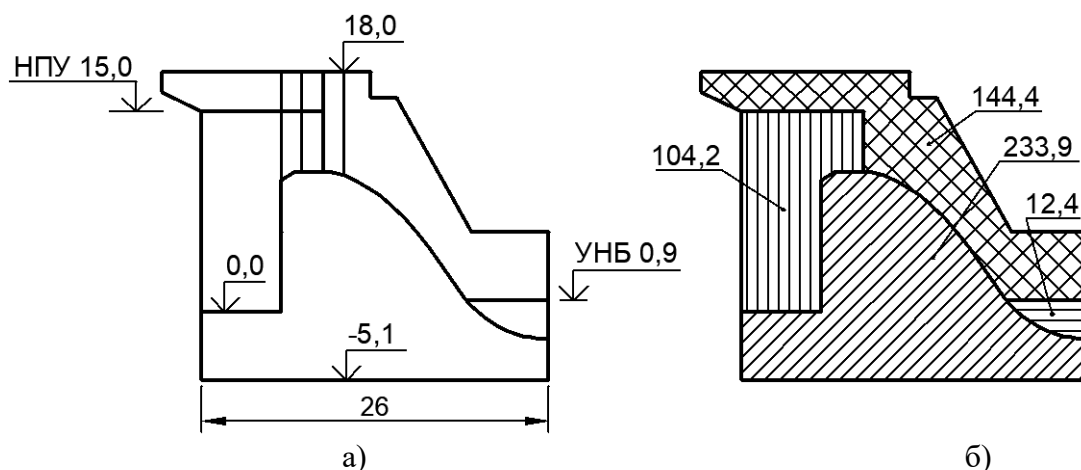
Исходные данные к расчёту нагрузок на бетонную водосливную плотину
